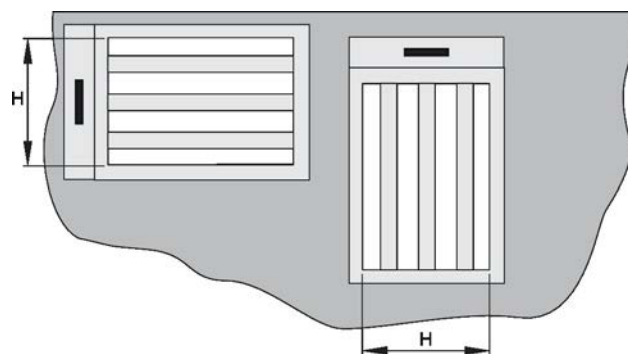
EK-JZ, posizione d'installazione orizzontale e verticale
